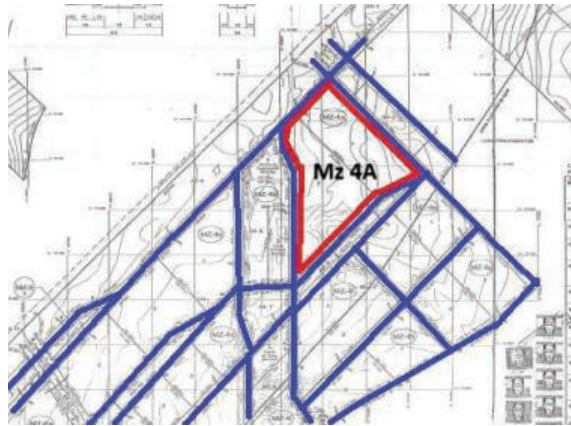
Red Vial Proyectada Macro Loteo Topater con Lote 4ª
